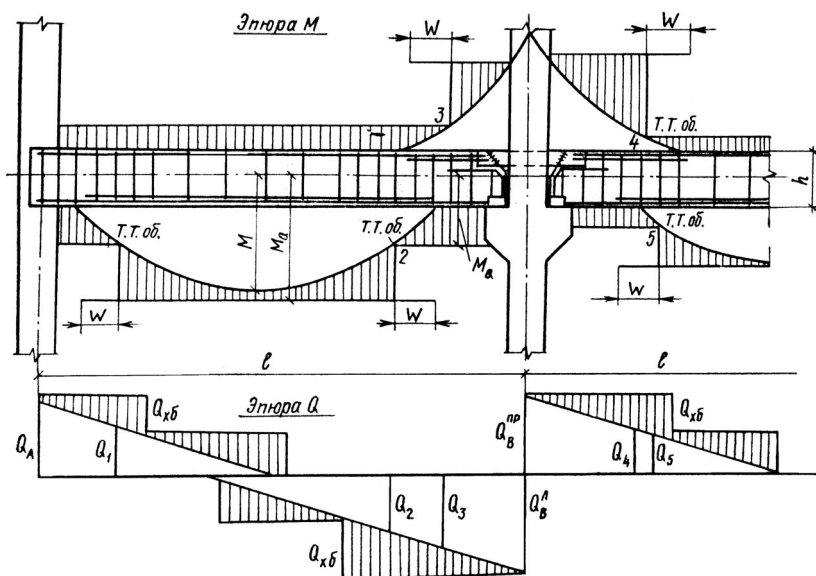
Эпюра материалов при армировании сварными каркасами
